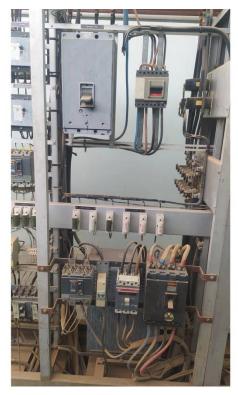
Les tableaux basse tension de la salle auxiliaire
